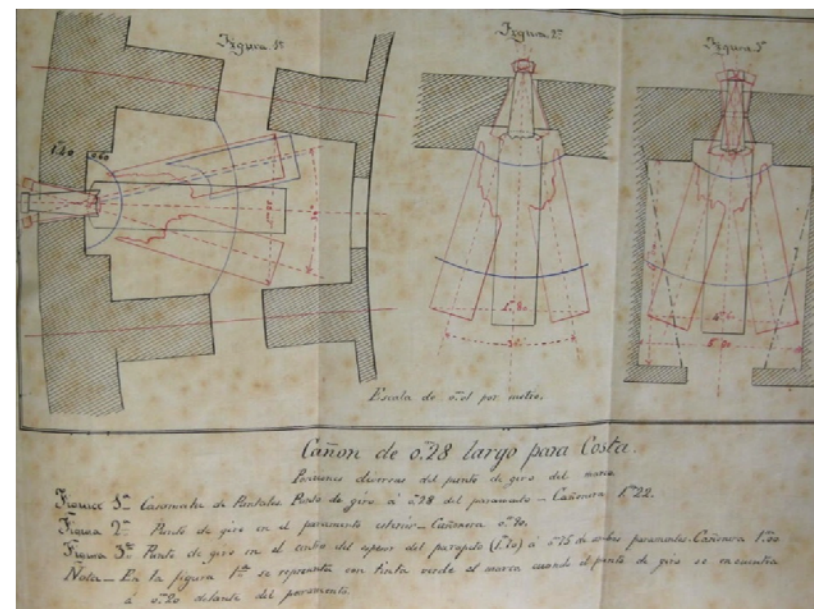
Plano de una pieza de artillería según el punto de giro.
